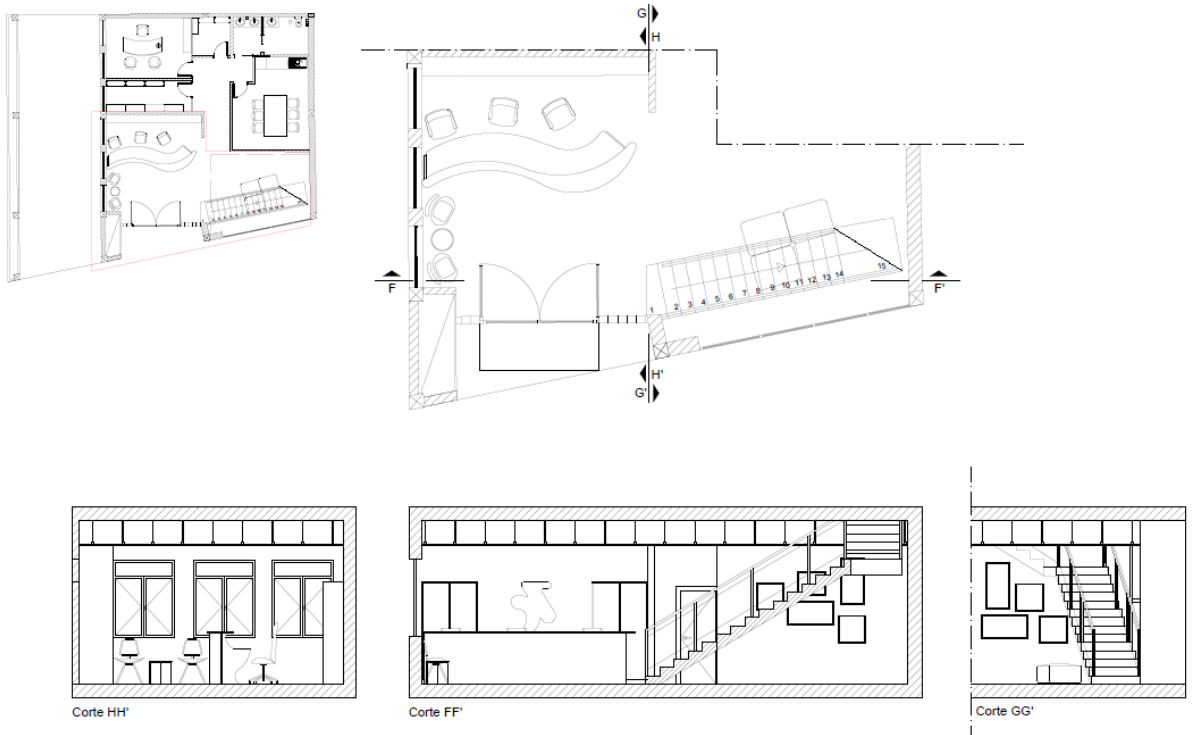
Pormenorização da zona de entrada. Fonte: Ana Cândido.
